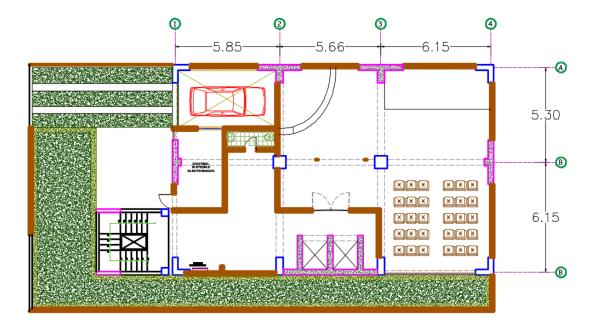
Plano Arquitectónico de la Planta 1º piso.
